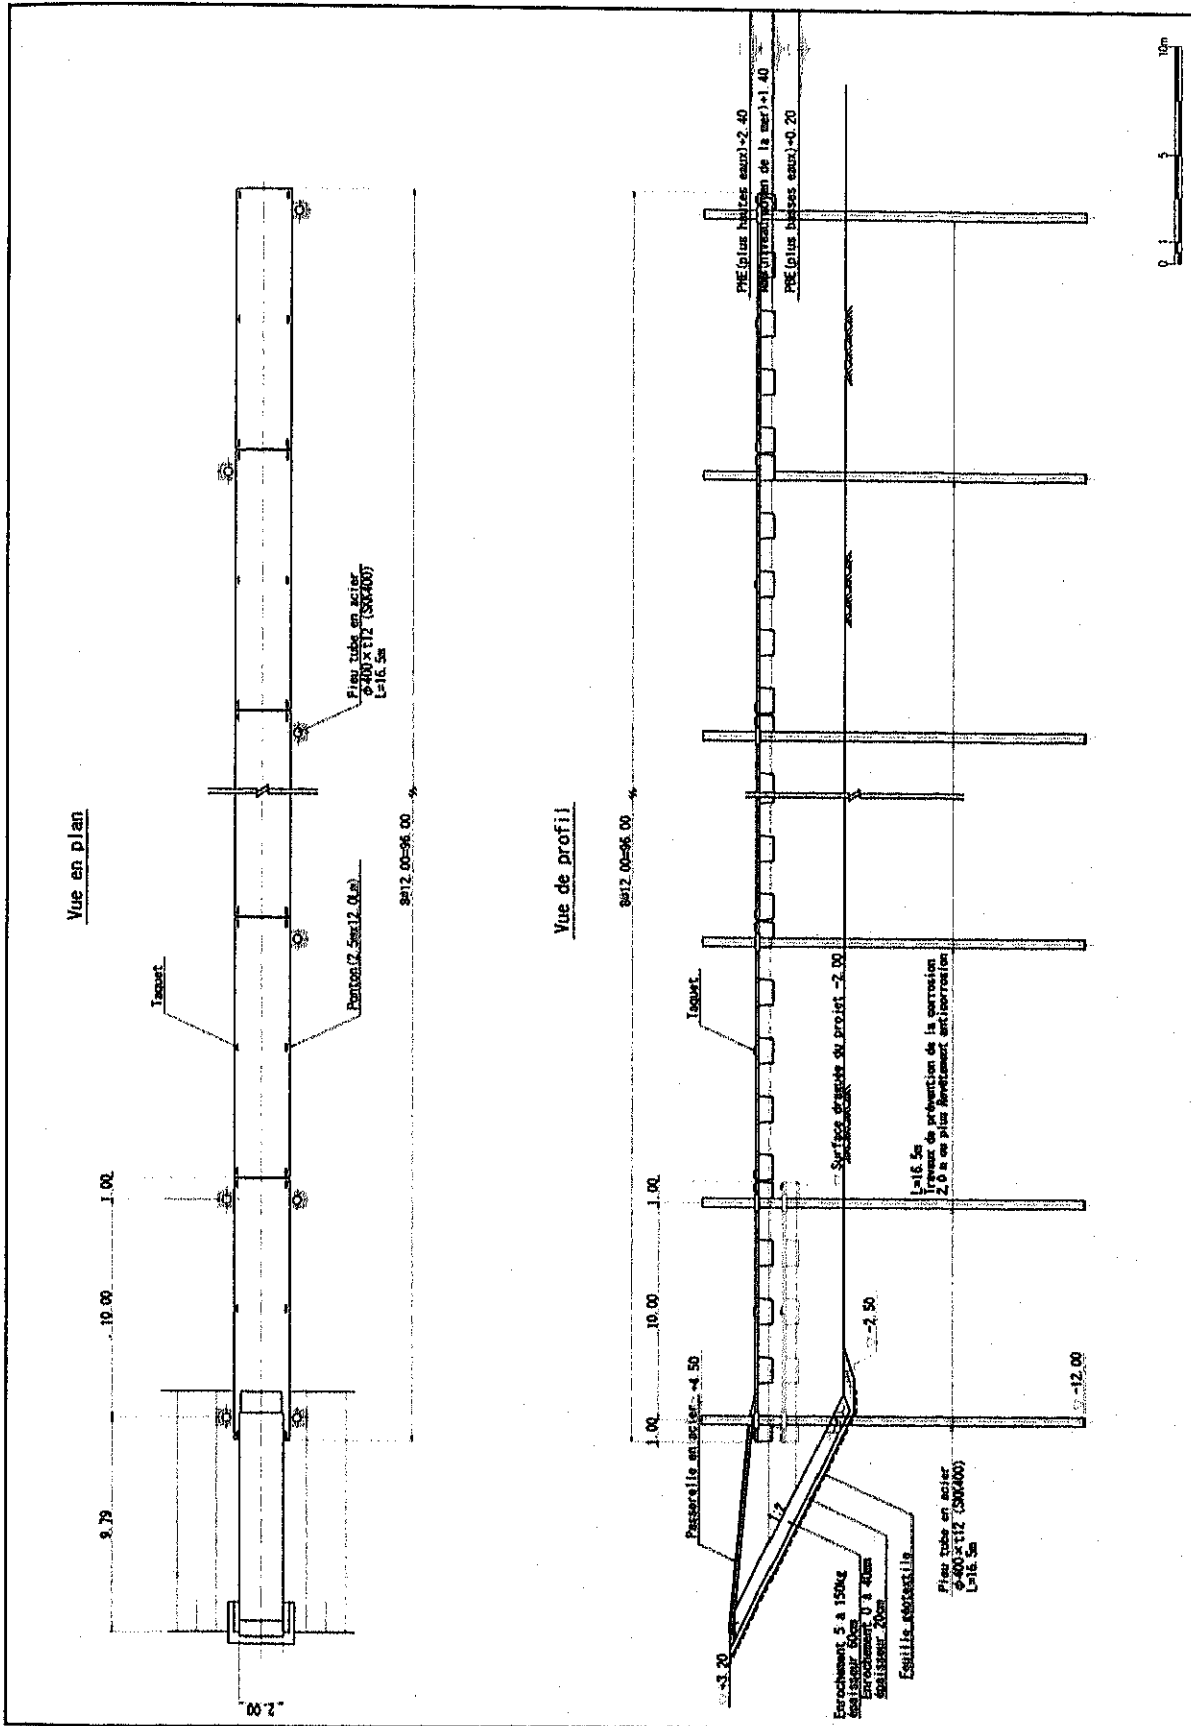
(13) Plan structural des pontons d'amarrage
